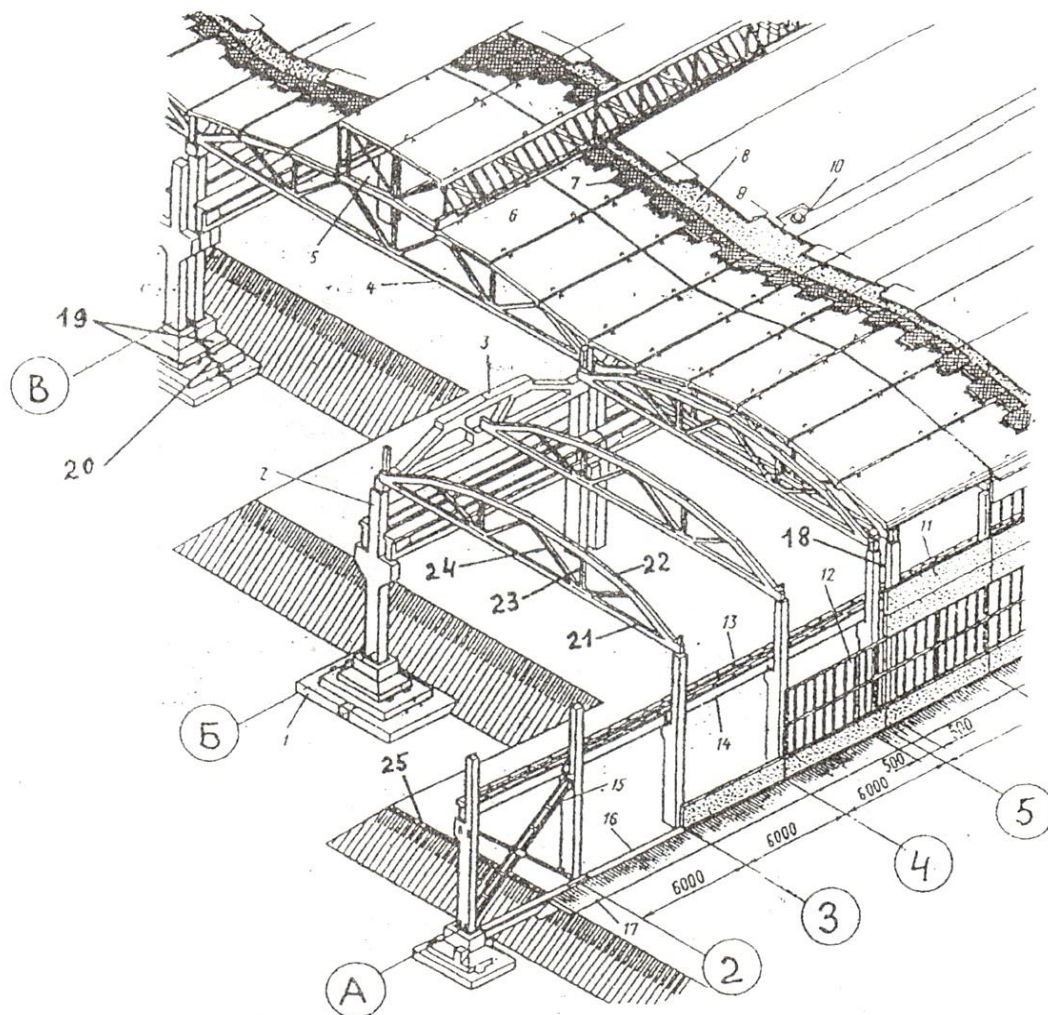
Железобетонный каркас одноэтажного производственного здания:
